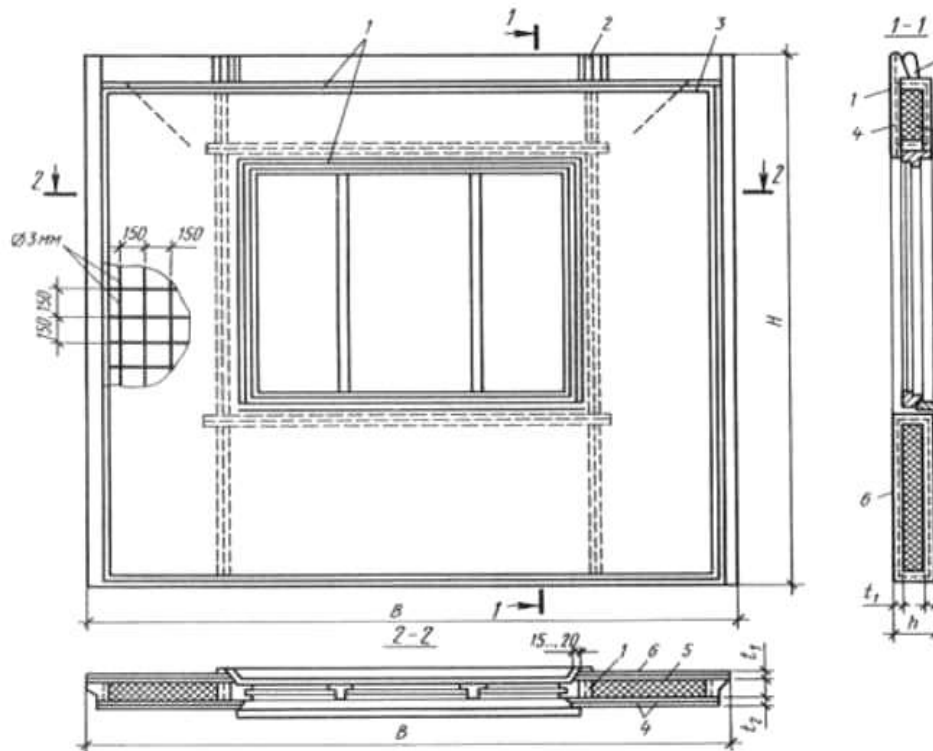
Тришарова стінова панель: 1 – зварні каркаси, вкриті бетоном; 2 – монтажні петлі; 3 – закладні деталі; 4 – арматурні сітки; 5 – утеплювач; 6 – важкий бетон
